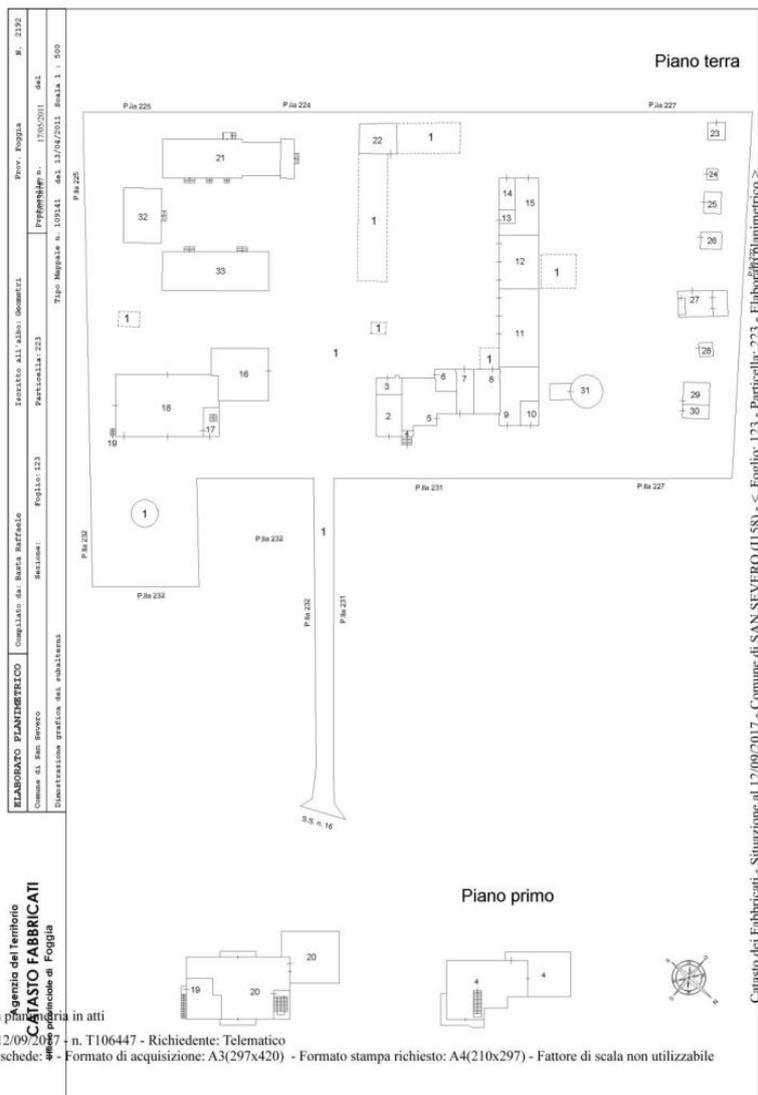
Elaborato planimetrico (Dimostrazione subalterni).
